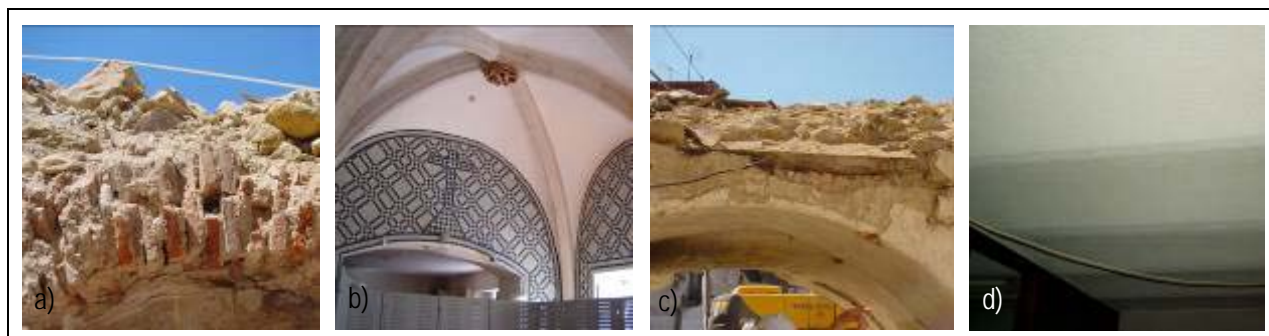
Outros tipos de pavimento: a) Arco em tijolo; b) Abóbada nervurada; c) Abóbada simples; d) Vigas em ferro e abóbadas em tijolo
